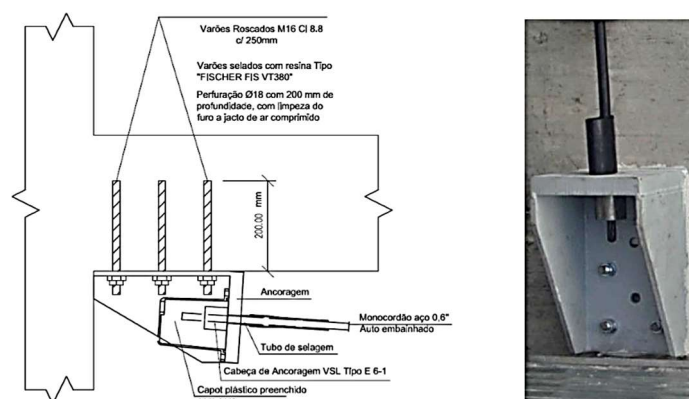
Ancoragem em aço ligada a uma estrutura de betão armado [40]
